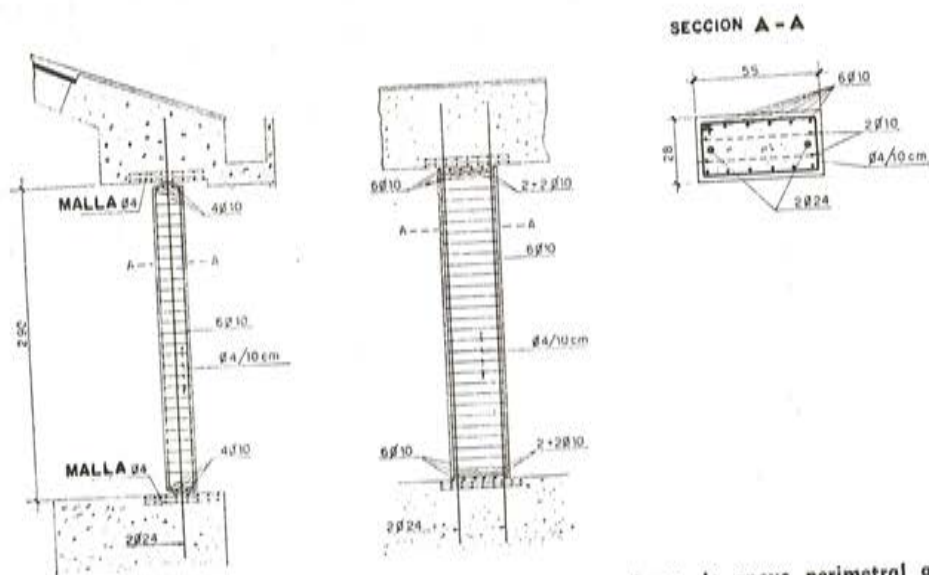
Disposición de armaduras en los montantes que sirven de apoyo perimetral a la cúpula
